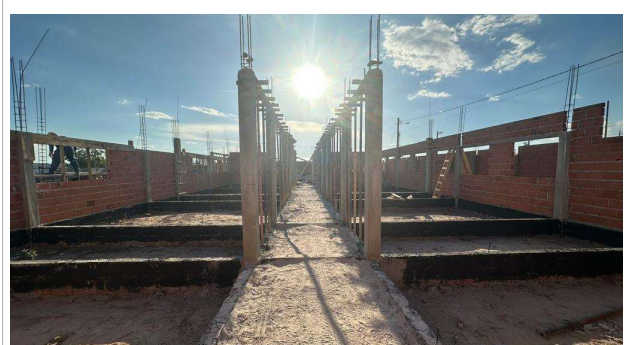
(2.0 Infraestrutura) – Pilares Concretados
